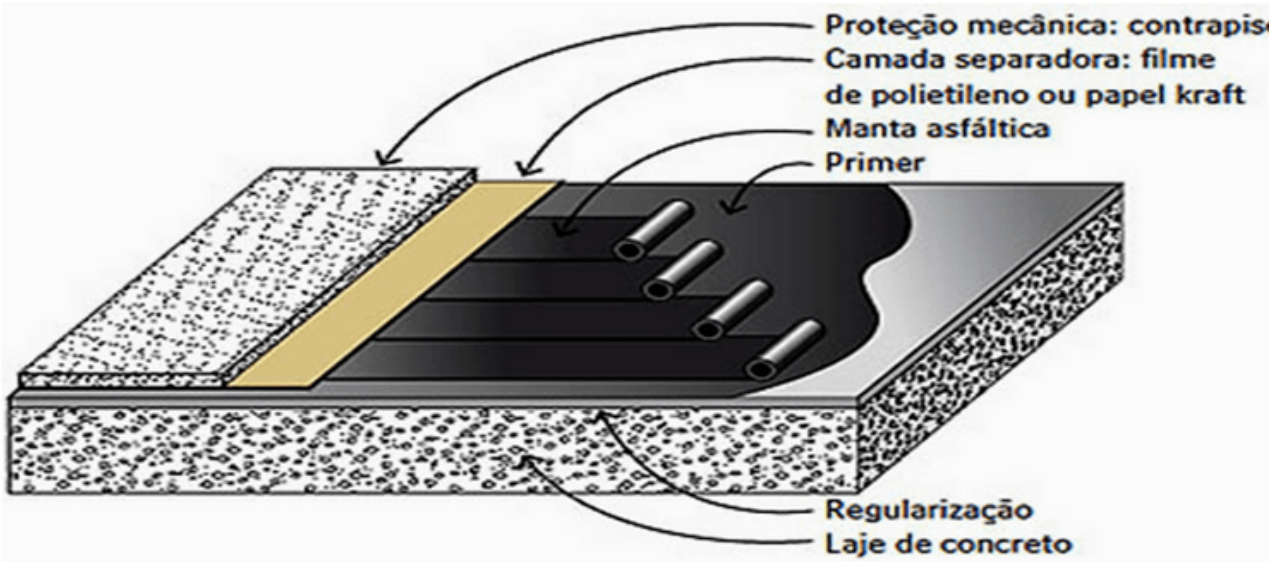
Etapas de impermeabilização de uma superfície de concreto
